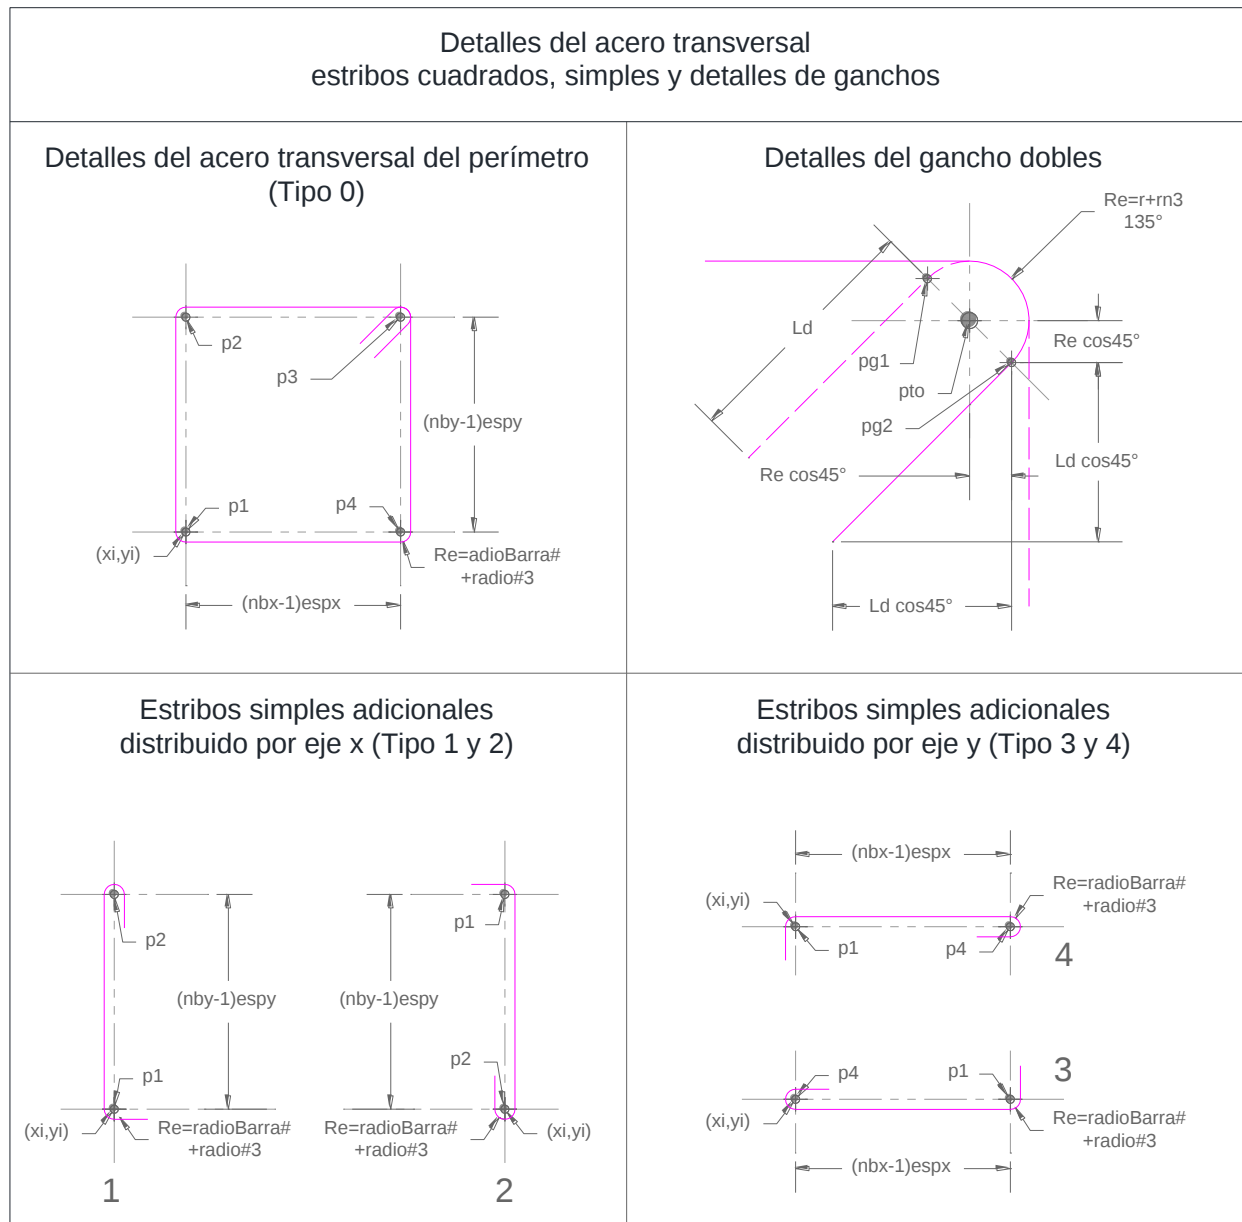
Detalle de estribos de perímetro, simples, y ganchos
